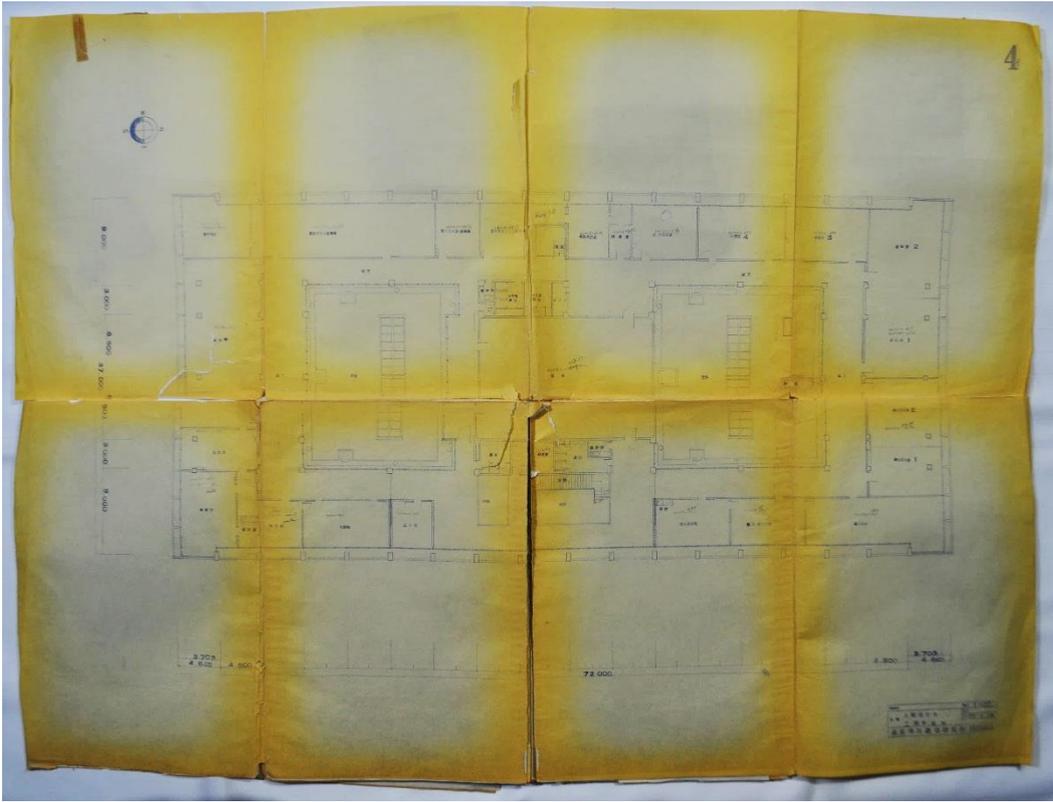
「設計図」上野市庁舎3階平面図 1963年(昭和38)10月8日(1:100)
